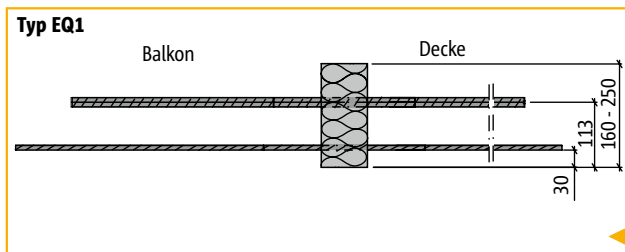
Mauerwerk mit Außendämmung bei deckengleichem Balkon + Typ Q+Q + Typ EQ1
